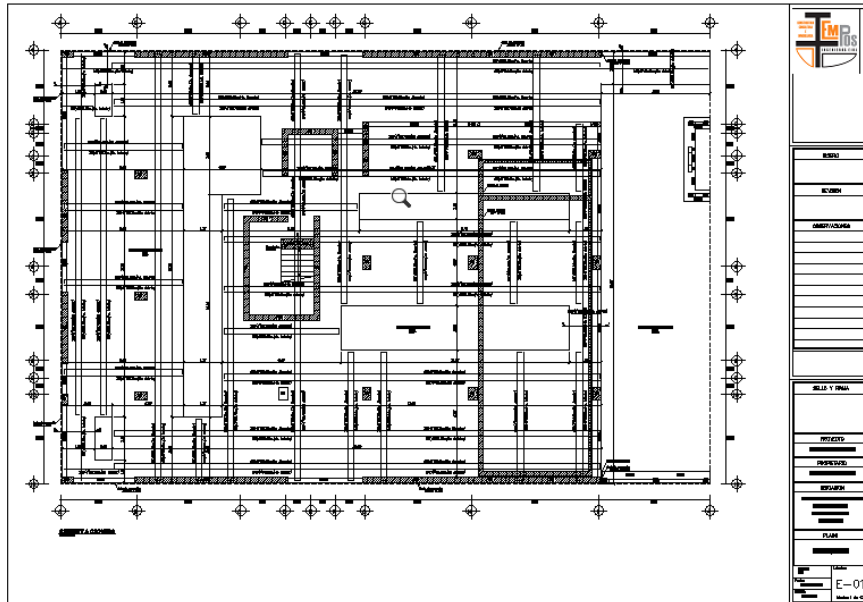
Planos de cimentación del Proyecto Residencial Los Nogales II
